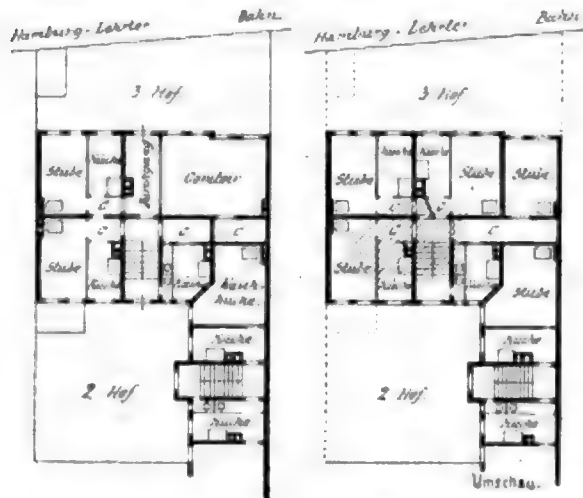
GRUNDRISSE der Brandstelle Lehrterstr. 38 in Berlin.
